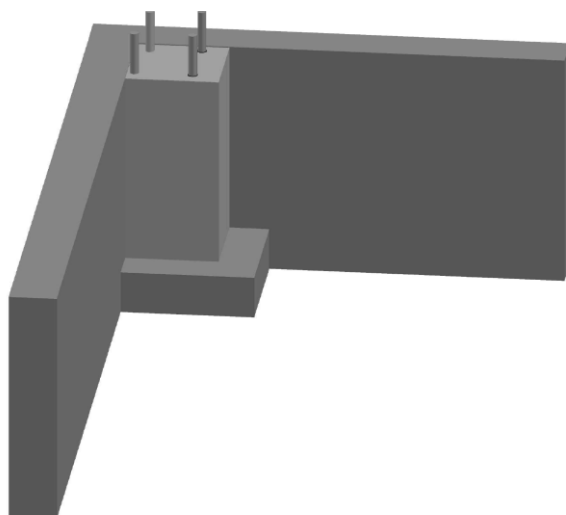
Армокаркас фрагмента стен с примыкание к колонне
